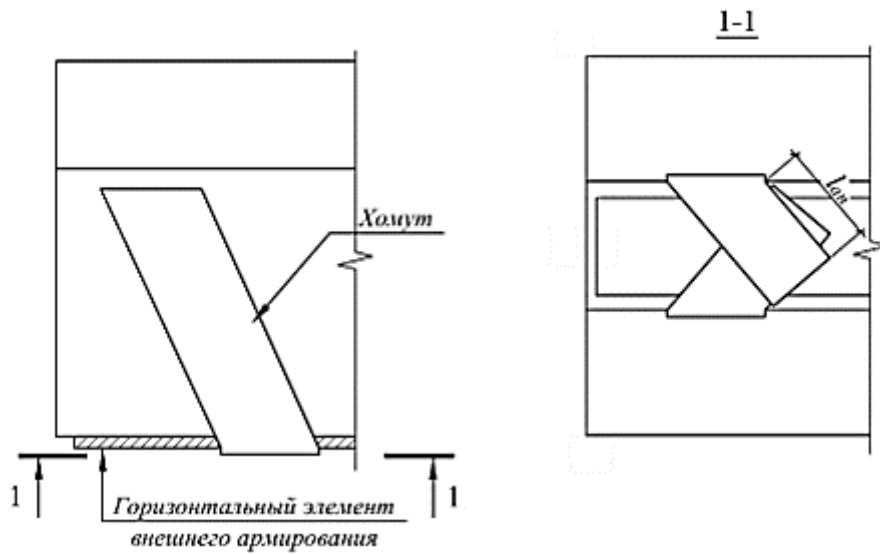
Схема установки наклонных хомутов в балочных конструкциях
